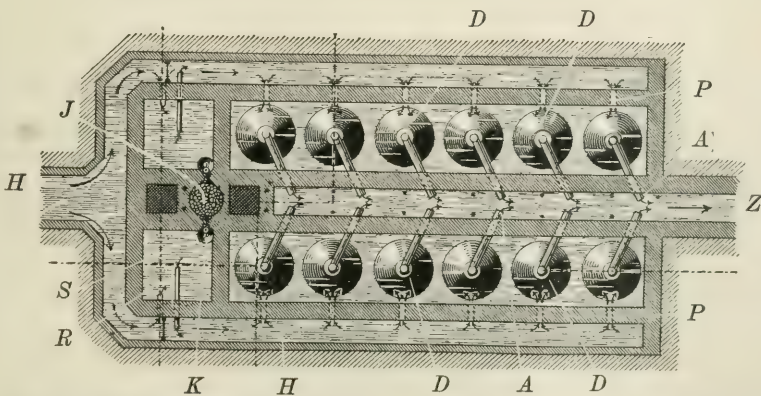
Kläranlage mit Stromteilung nach Patent Dervaux. Grundriss.
